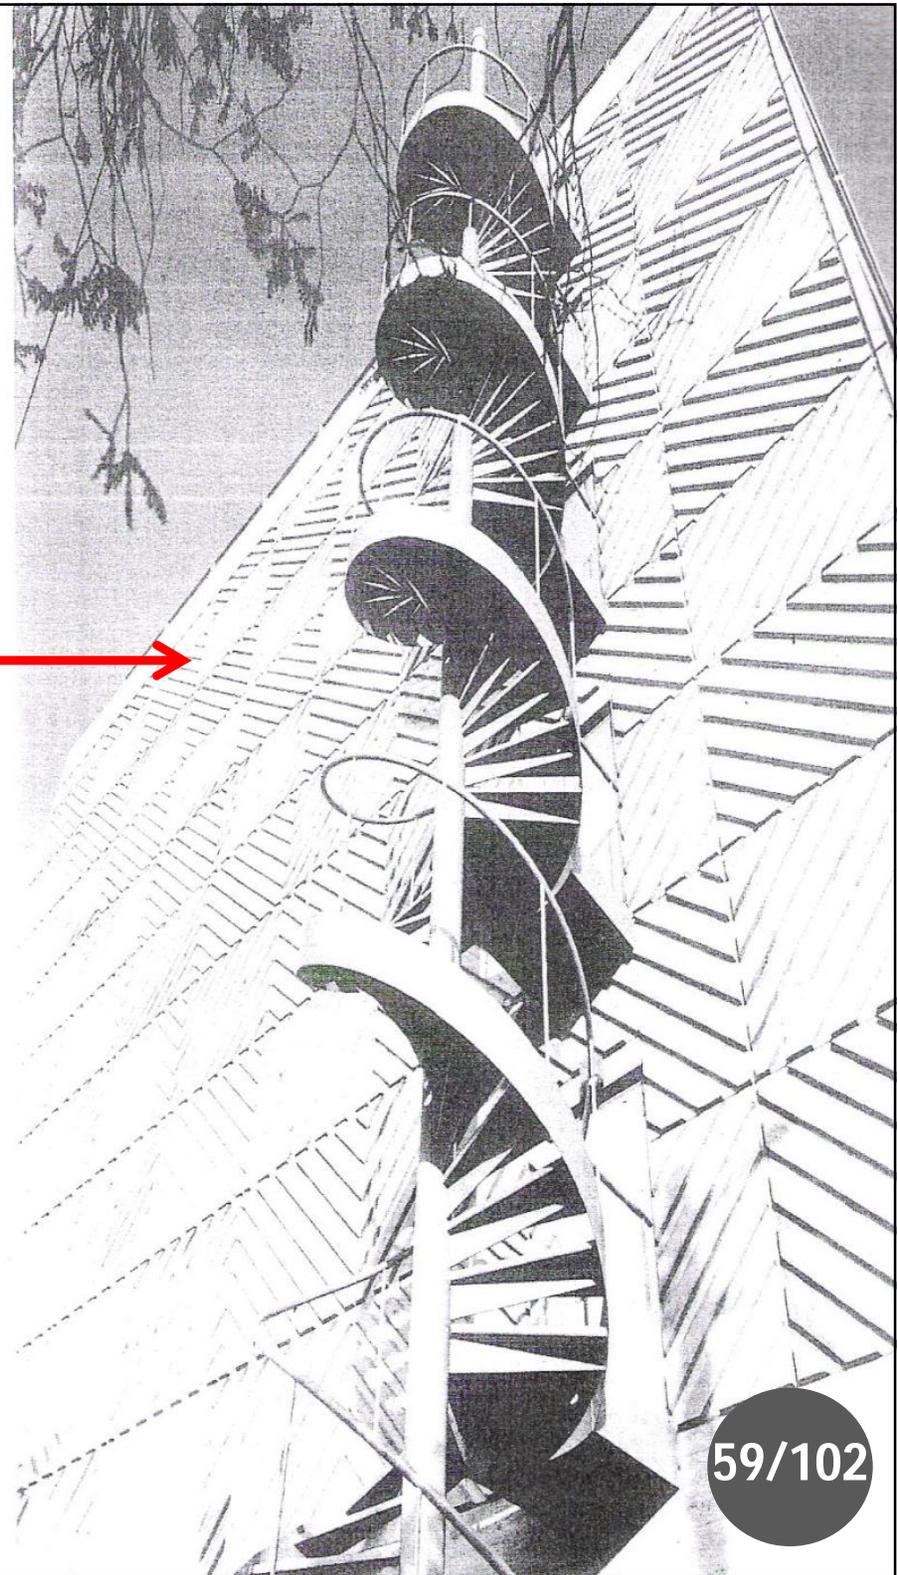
Detalhe da fachada Almacén Iwanami ,
